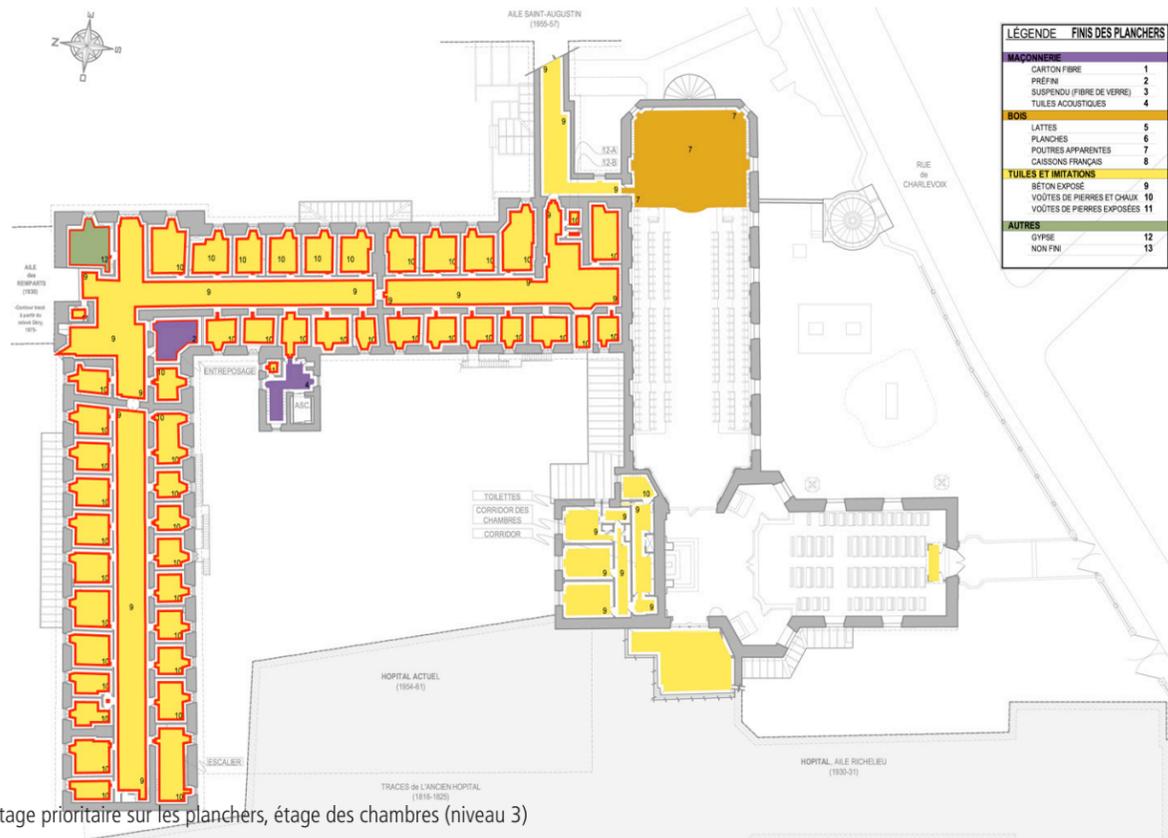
Plan de curetage prioritaire sur les planchers, étage des chambres (niveau 3)
